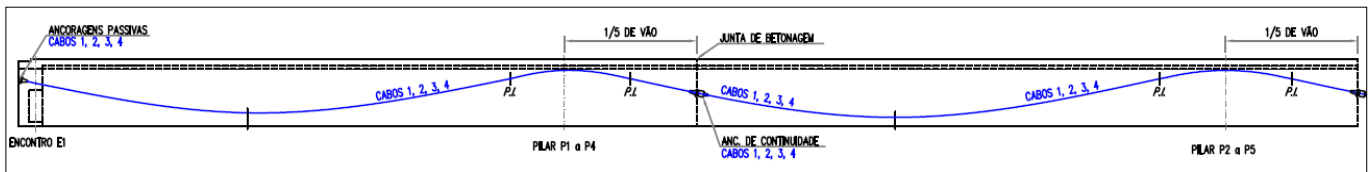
ANDAMENTO DO TRAÇADO DE PRÉ-ESFORÇO DE OBRAS CONSTRÚIDAS DE TRAMO A TRAMO
